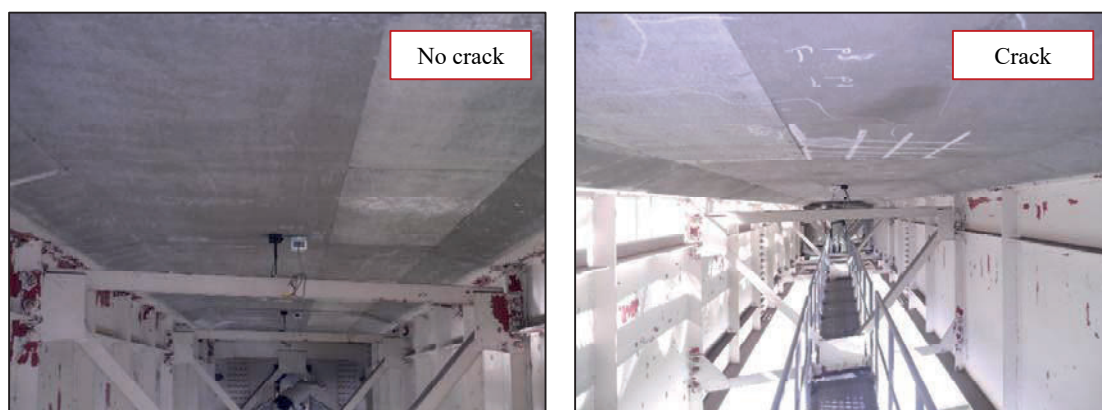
橋 E-1 の床版写真（左：ひび割れ無し，右：ひび割れ有り）
